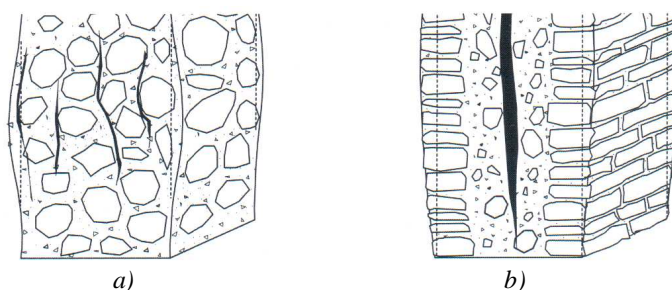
Modos de falla típicos de la mampostería de piedra irregular según el arreglo de los materiales que la componen. a) Falla por abultamiento, b) Falla por separación de las piezas en un plano débil (Meli, 1998)
